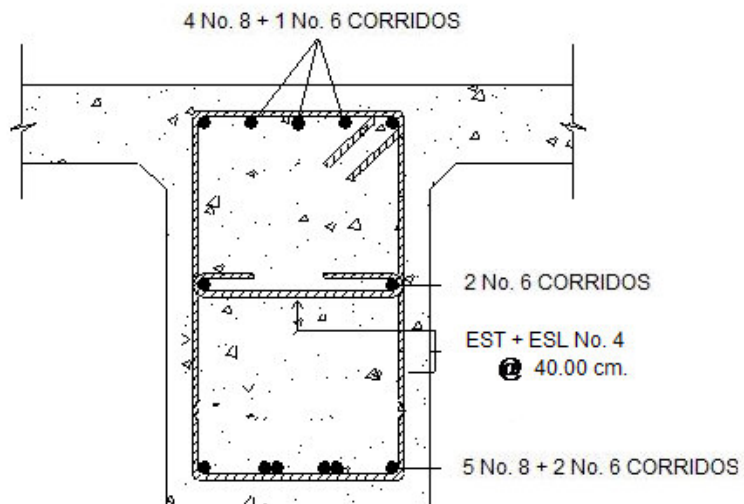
Detalle de armado de viga interna a 2.75 m del apoyo
